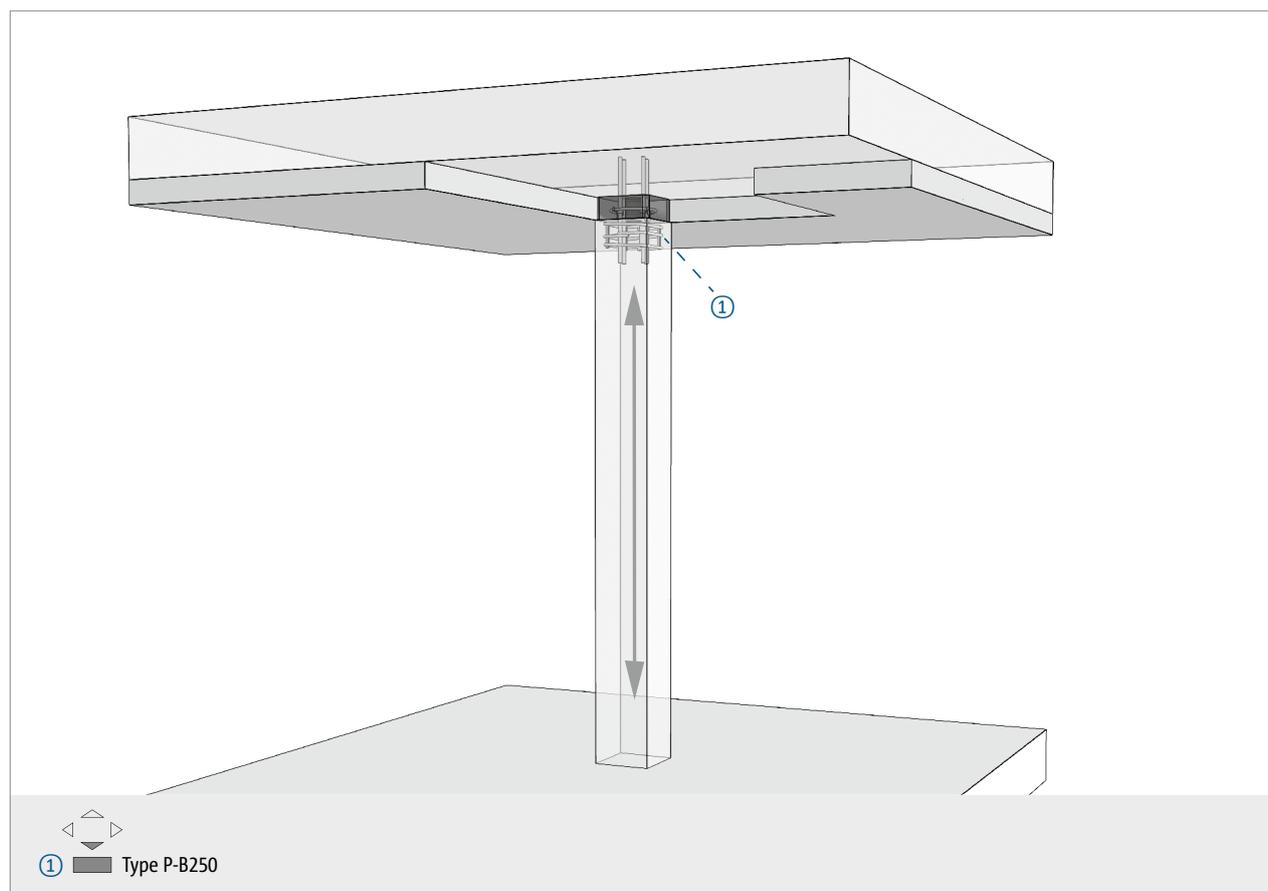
Raccordement de poteau en cas d'isolation sous la dalle
